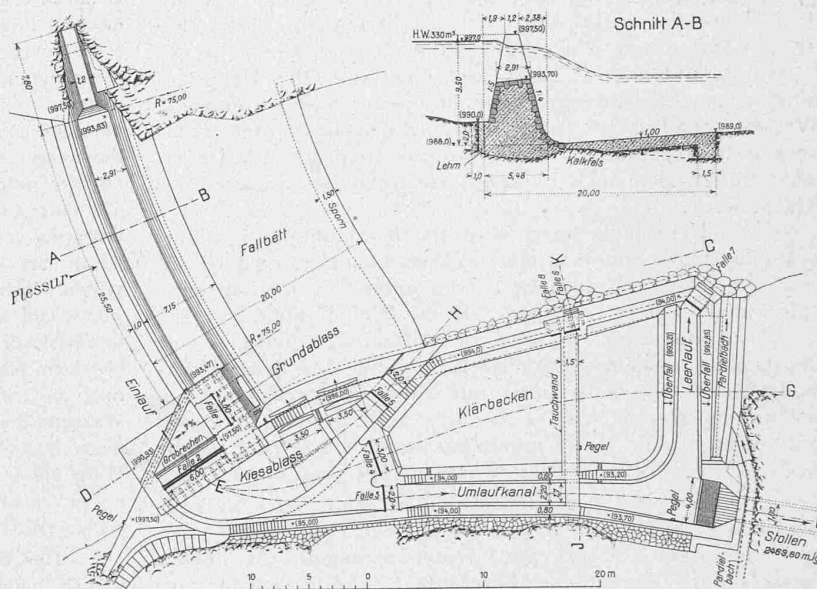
Grundriss der Wasserfassung und Querschnitt des Wehrs. — 1 : 600.
